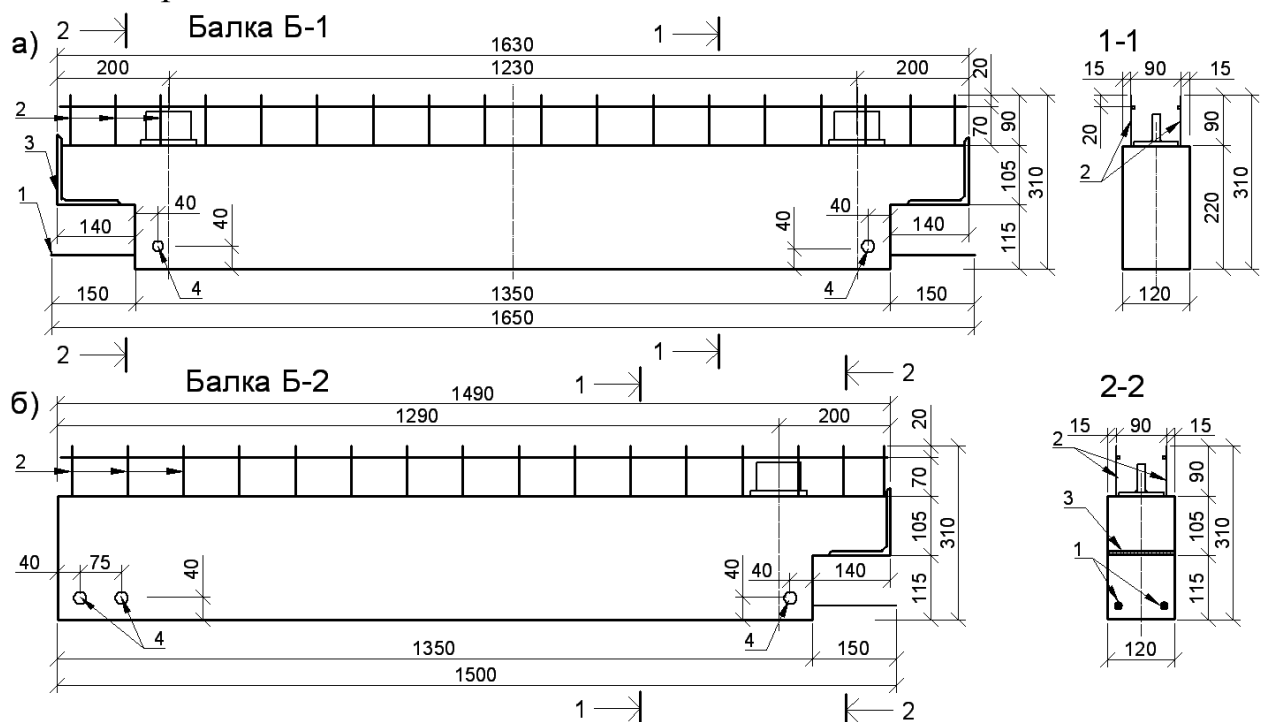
Збірні залізобетонні балки: а) Б-1 – для середніх прогонів, б) Б-2 – для крайніх прогонів. 1- випуски робочої арматури, 2 – випуски вертикальних стержнів, 3 – кутник 100x100x8 мм, 4 – закладна трубка d20 мм.
